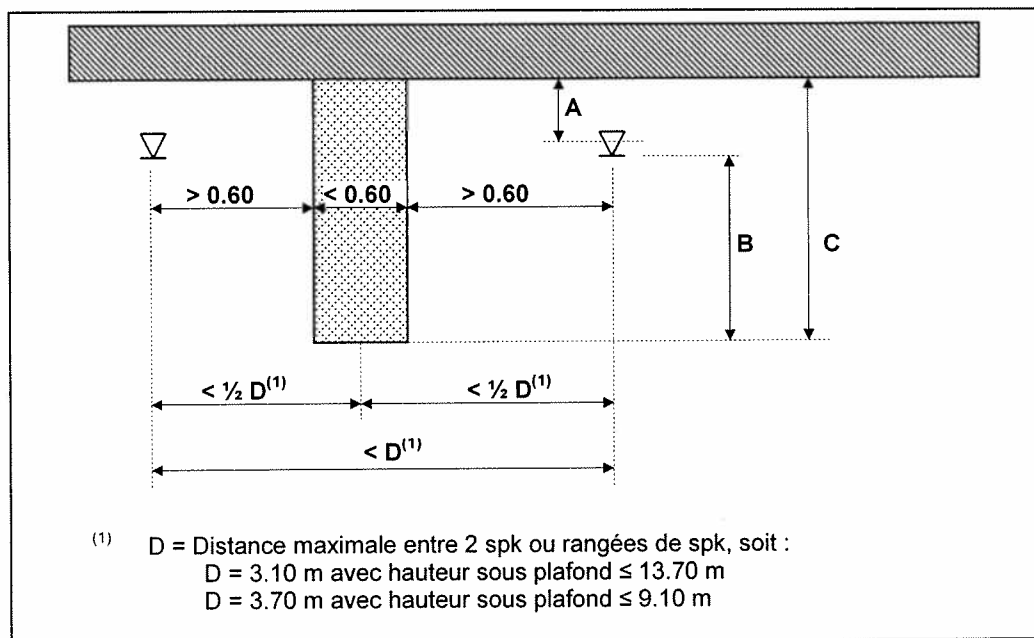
α : Protection ESFR - position des sprinkleurs par rapport aux poutres
